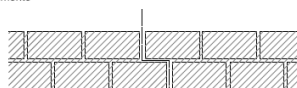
Junta de movimiento con solape. Esquema en planta
